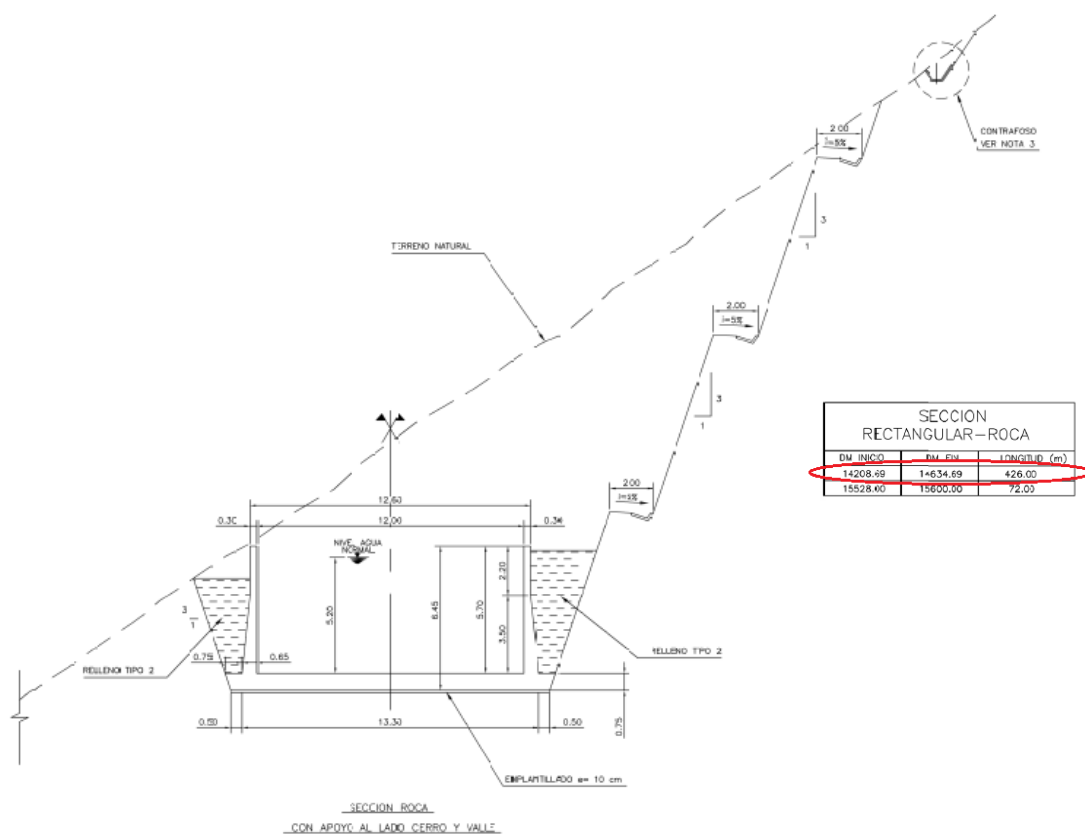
Sección en Roca con apoyo al lado cerro y valle. Desde el DM 14.208 al DM 14.534 (426 mts).
